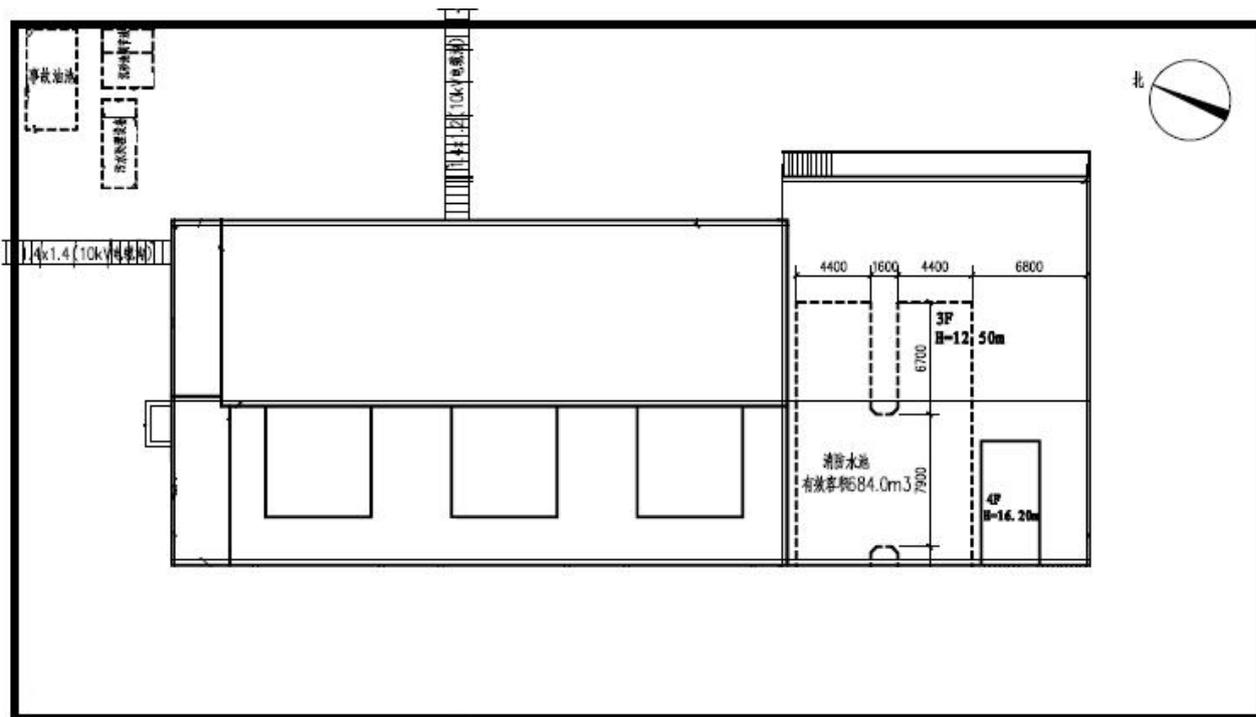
惠州 110 千伏智博（凤山）变电站总平面布置示意图
